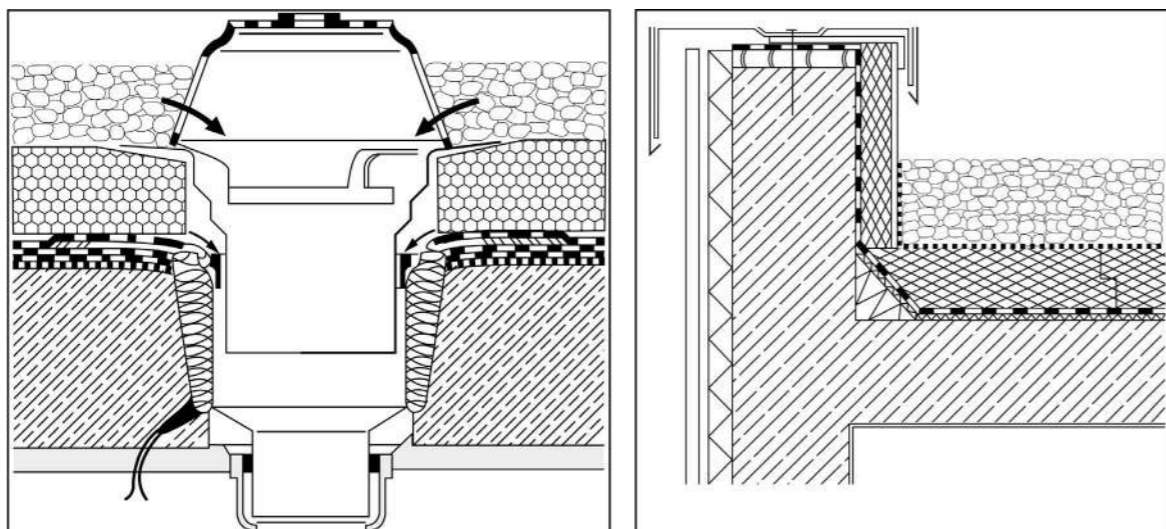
Detalles. Izquierda: encuentro con desagües. Derecha: encuentro con murete perimetral
